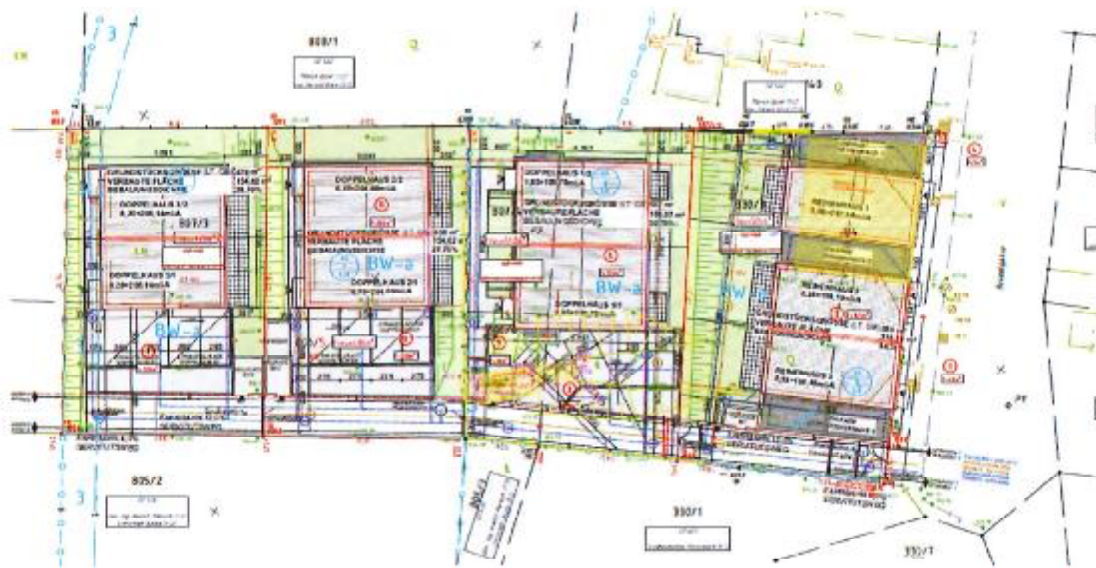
Einreichplan 26.08.2019 | Lageplan
